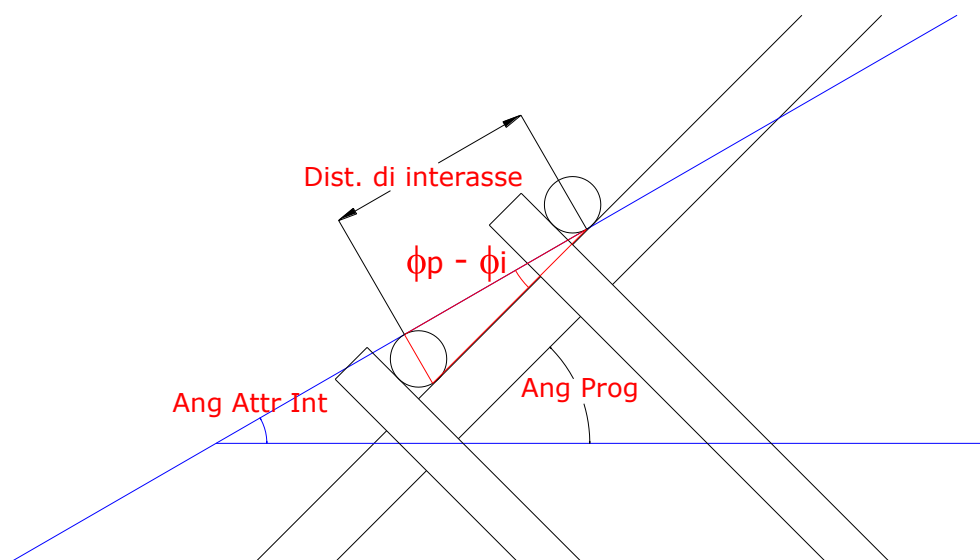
Sezione dell'interasse tra gli elementi orizzontali della grata semplice.
